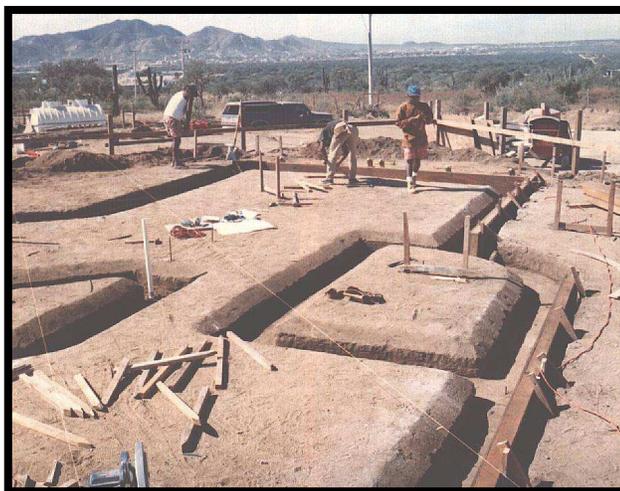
Trazado de cimentación para muros de tridipanel.
